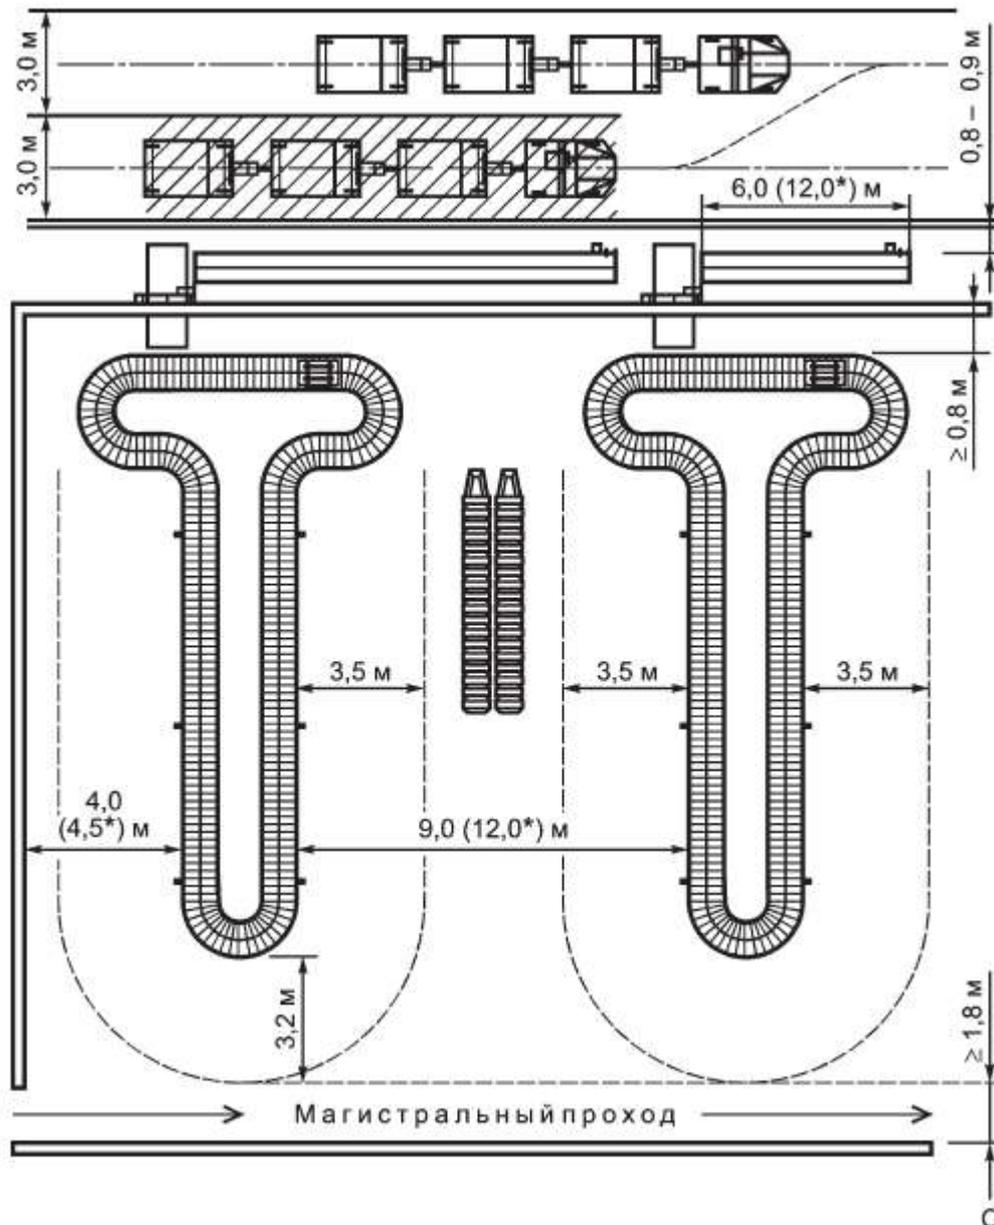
Минимальные габаритные размеры зоны обработки и сортировки багажа
